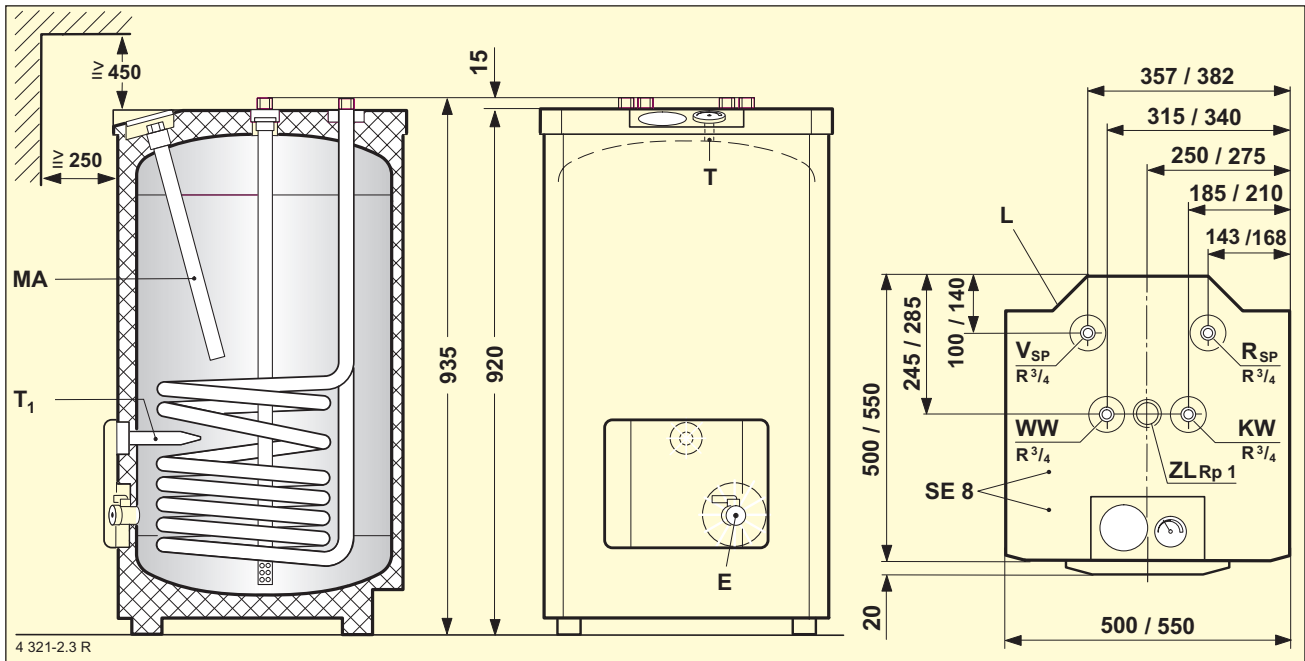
Bau- und Anschlussmaße ST 120-1 E. und ST 160-1 E. (Maßangaben hinter einem Schrägstrich beziehen sich auf die größere Speicherausführung)
